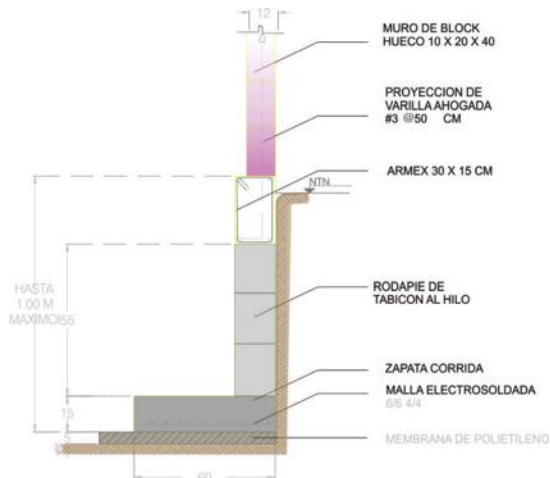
CORTE CONSTRUCTIVO MUROS DE BLOCK.
